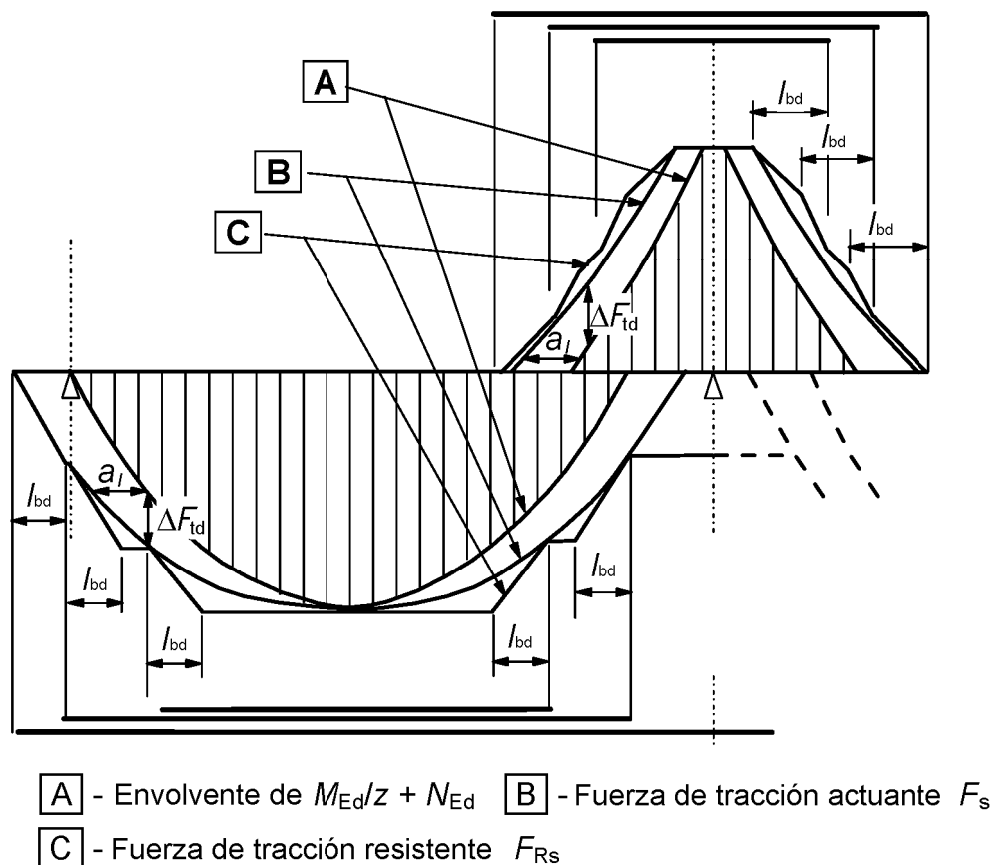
Ilustración del decalaje de la armadura longitudinal, teniendo en cuenta el efecto de fisuras inclinadas y la resistencia de la armadura dentro de las longitudes del anclaje
